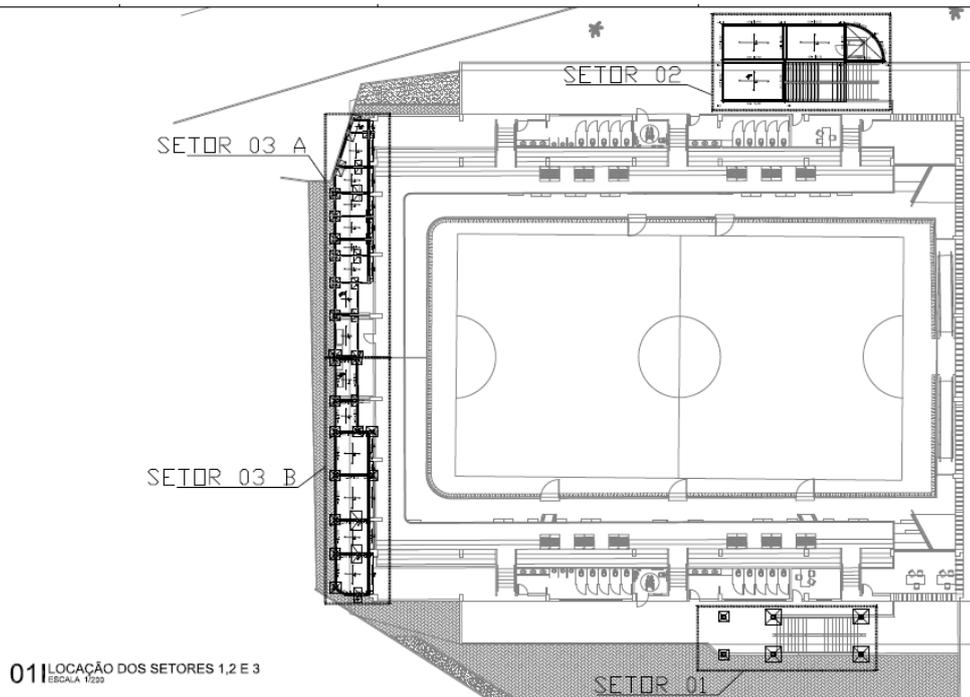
Locação de setores de intervenção na estrutura de concreto
